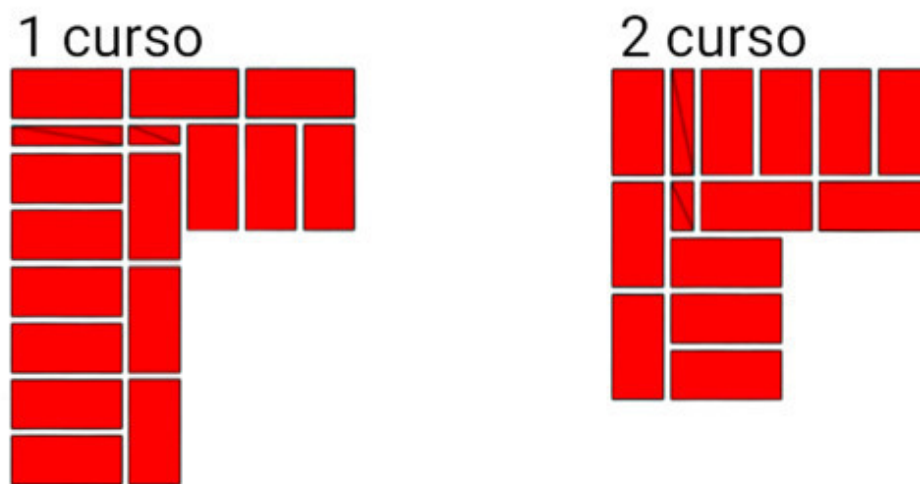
A ordem de colocar tijolos no canto das paredes. Espessura da parede 1,5 tijolos.
